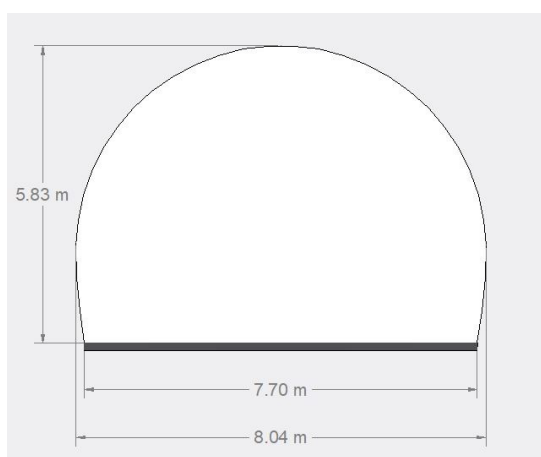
sezione trasversale semplificata della galleria stradale di Framura (SP)
